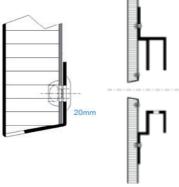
Detalles de fachadas ventiladas de paneles honeycomb.
